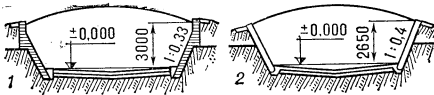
Полузаглублённые траншеи: 1 — из кирпича; 2 — из железобетонных плит.
